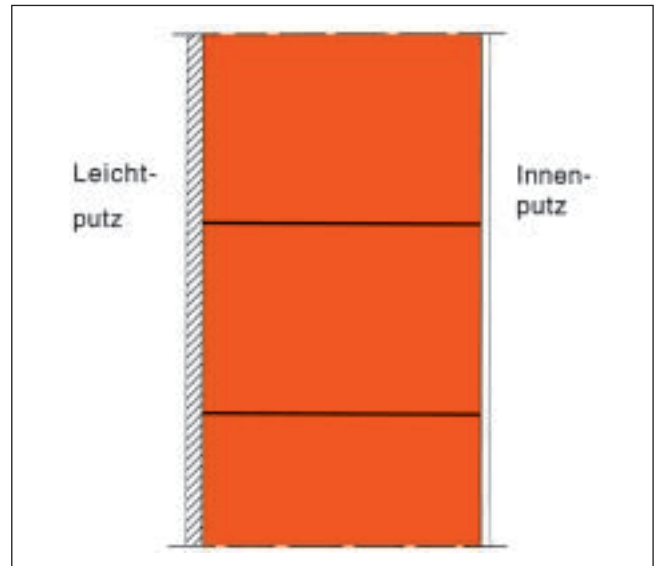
Schnitt durch einschaliges PlanZiegel-Mauerwerk
